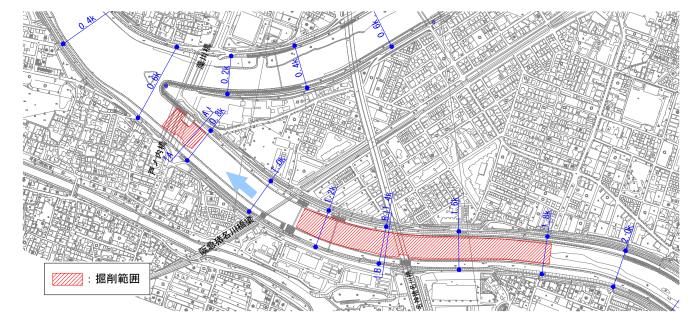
戸ノ内(H25 工事)地区 平面図
